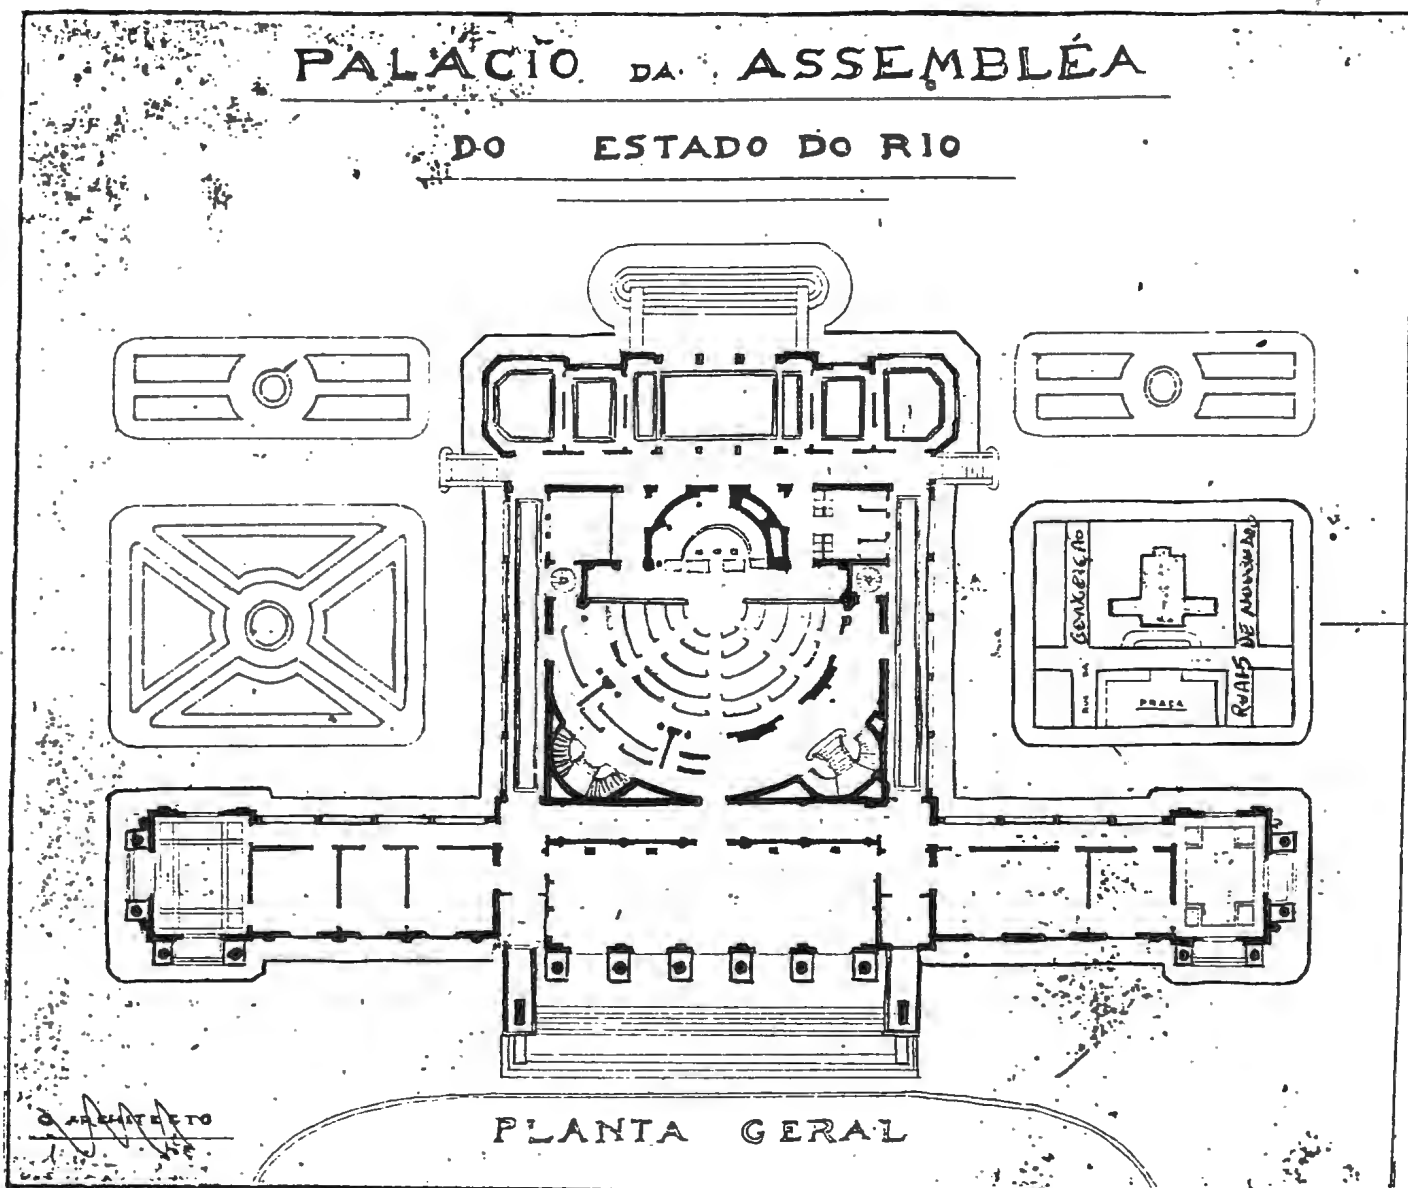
Planta do 1º pavimento da antiga Assembléia Legislativa localizada na Praça Gomes Carneiro.
